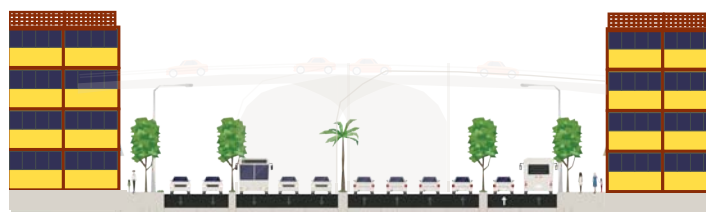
Sección de Fray Servando Teresa de Mier
